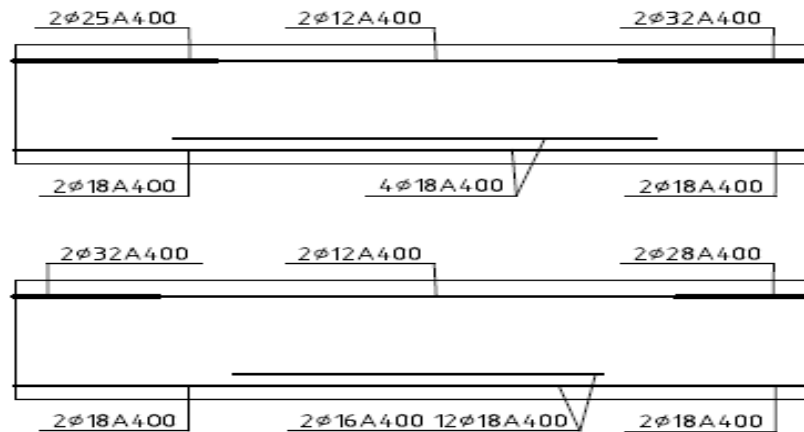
Армирование ригеля продольной рабочей арматурой:
